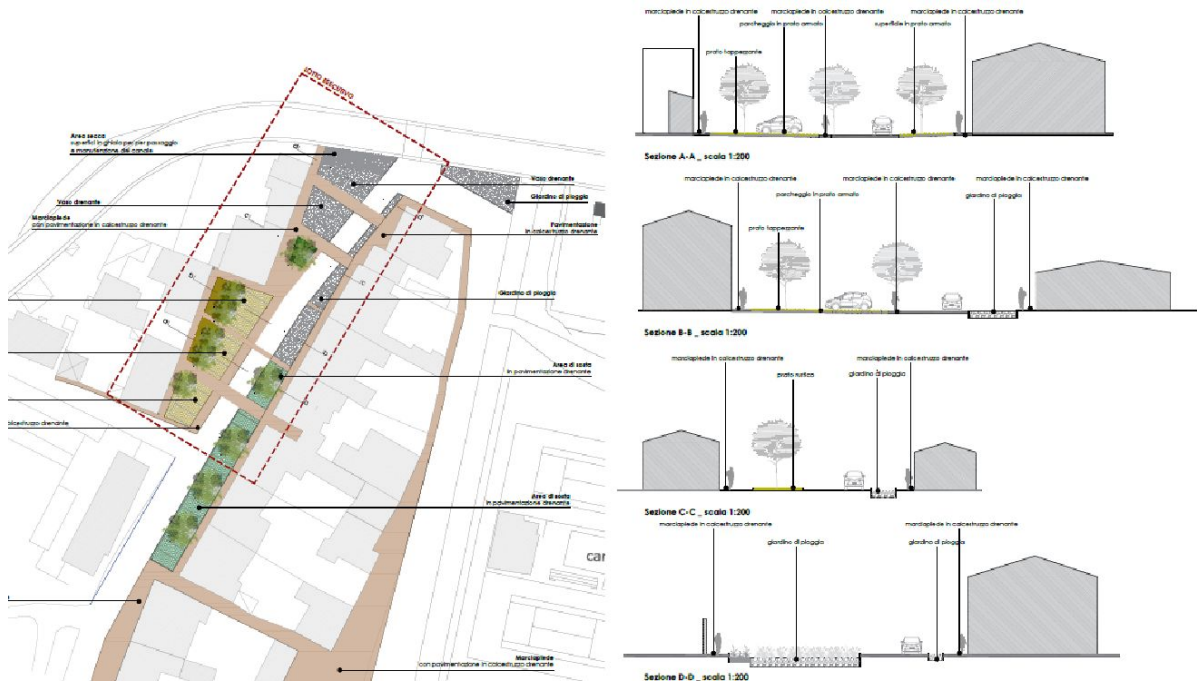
Extrait du tableau "Masterplan du projet", avec indication du lot exécutif, de l'intervention pilote COLANDER.
